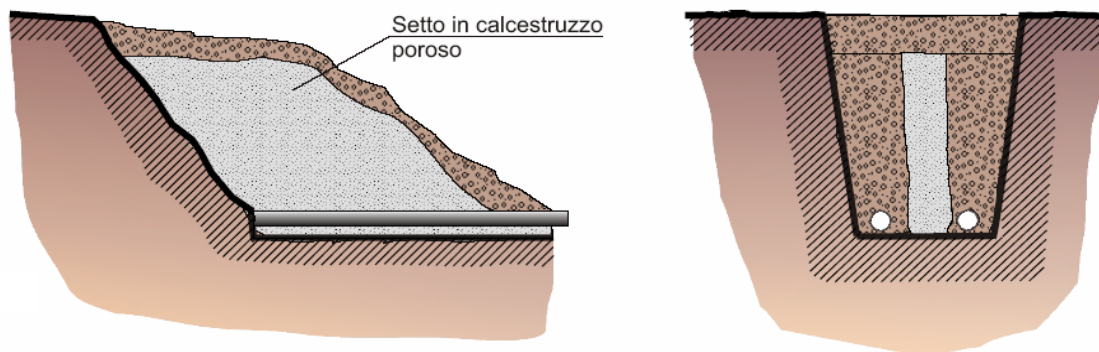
Rappresentazione schematica di uno sperone drenante con setto centrale in calcestruzzo poroso (da ANPA, 2002) -
